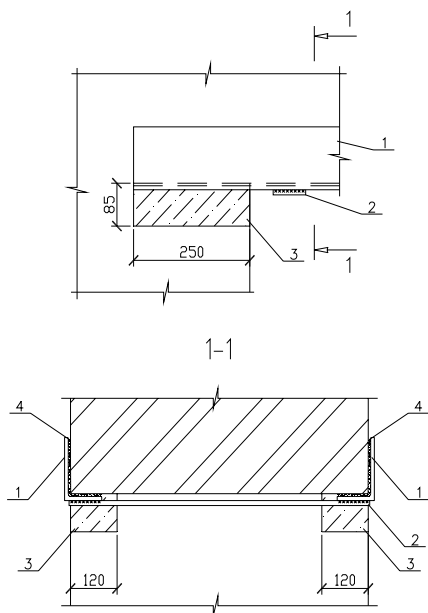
Фрагмент (опорная часть) конструкции усиления перемычек : 1 – прокатный уголок (L125х80х8), 2 – соединительная планка (-8х70), 3 – бетонный камень (класс бетона В20), 4 – цементно-песчаный раствор марки не ниже М100
